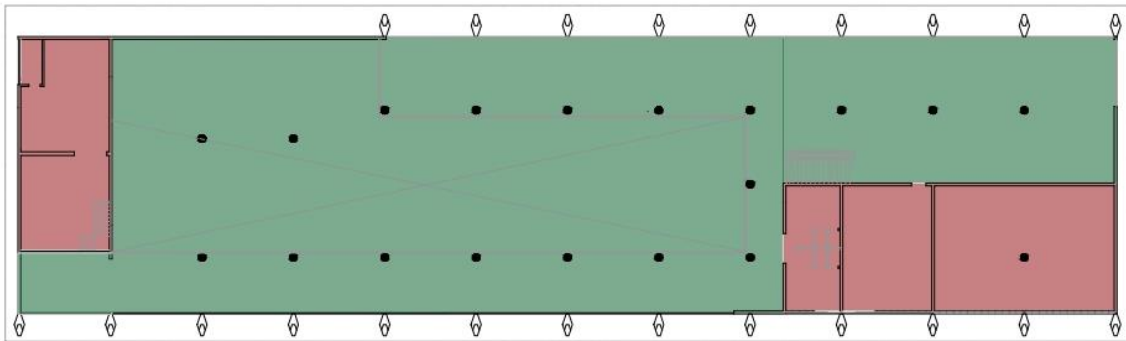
s.d. / Esquema da planta do pavimento superior do Terminal Rodoviário Luís Garcia. ©DER. Planta modificada pela autora.
